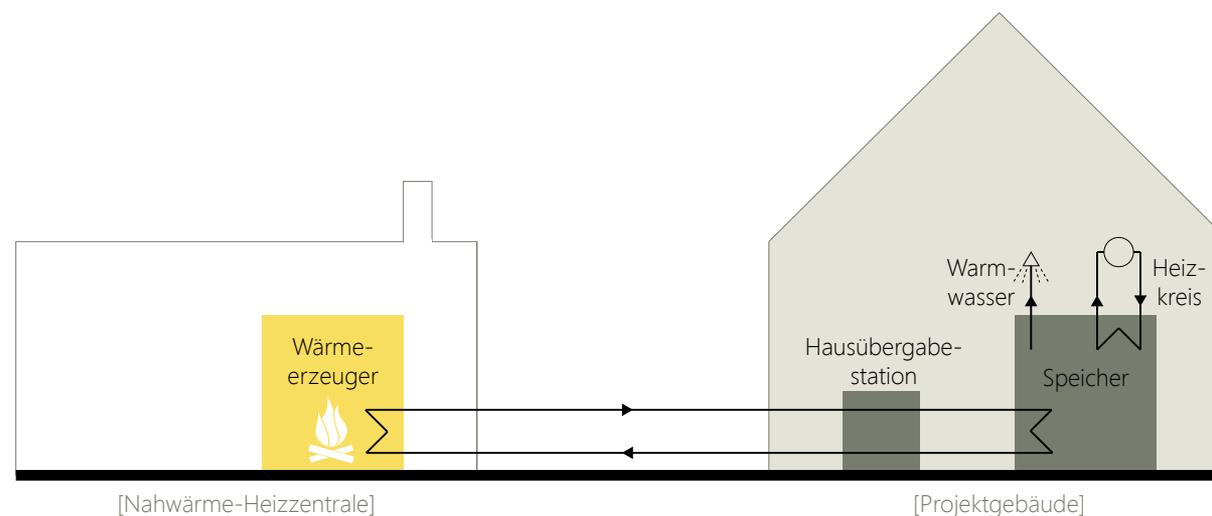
Funktionsschema der Wärmeversorgung im Projektgebäude
